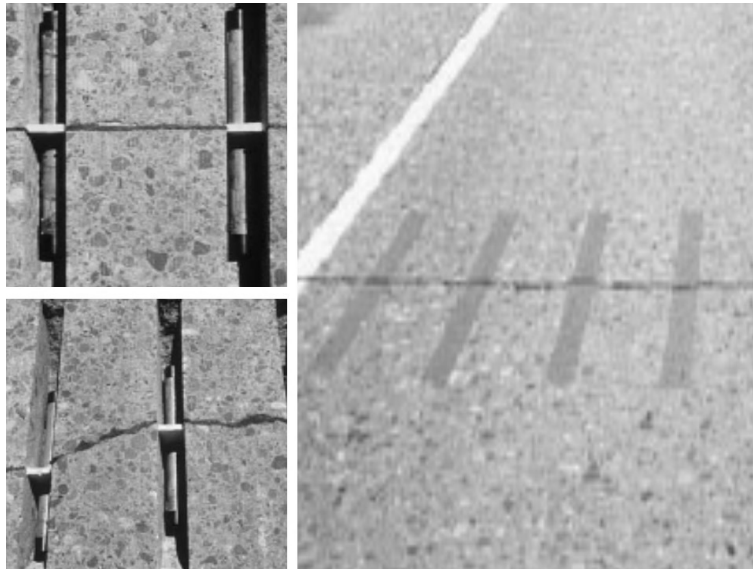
Posicionamiento de pasadores en juntas y fisuras, y vista de trabajo terminado
